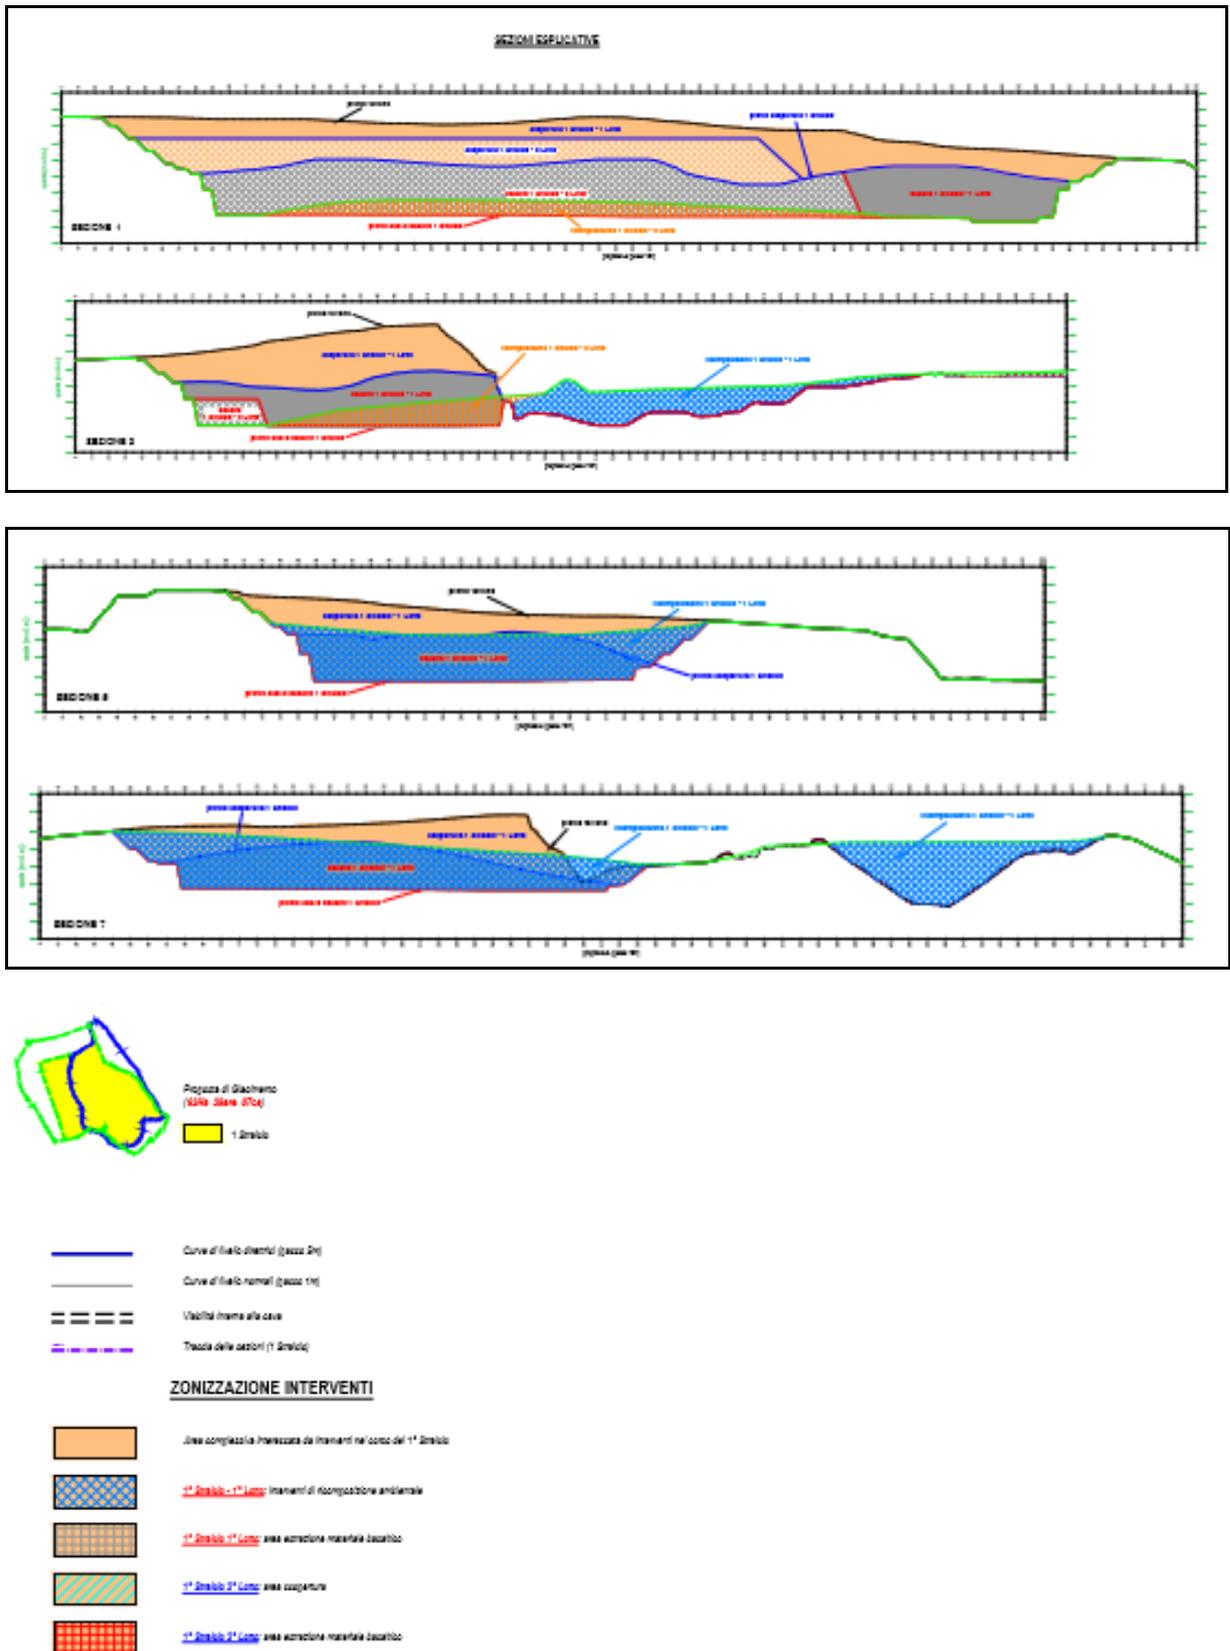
Schema di avanzamento coltivazione, Suddivisione 1° Stralcio Funzionale in Lotti
